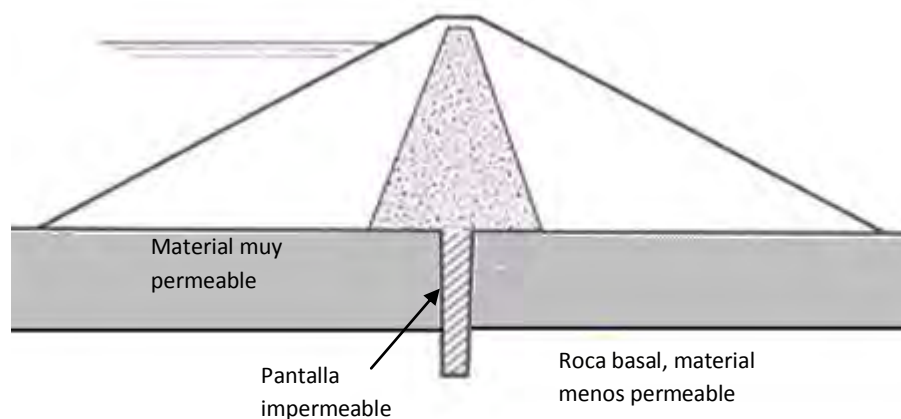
Pantalla impermeable construida hasta la roca basal.
